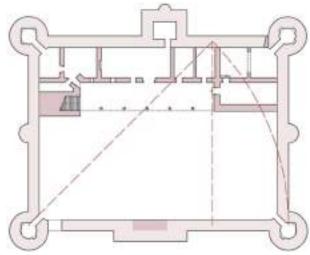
Planta baja del palacio de Castronuevo tras las primeras obras del II duque de Alba. Elaboración propia.
